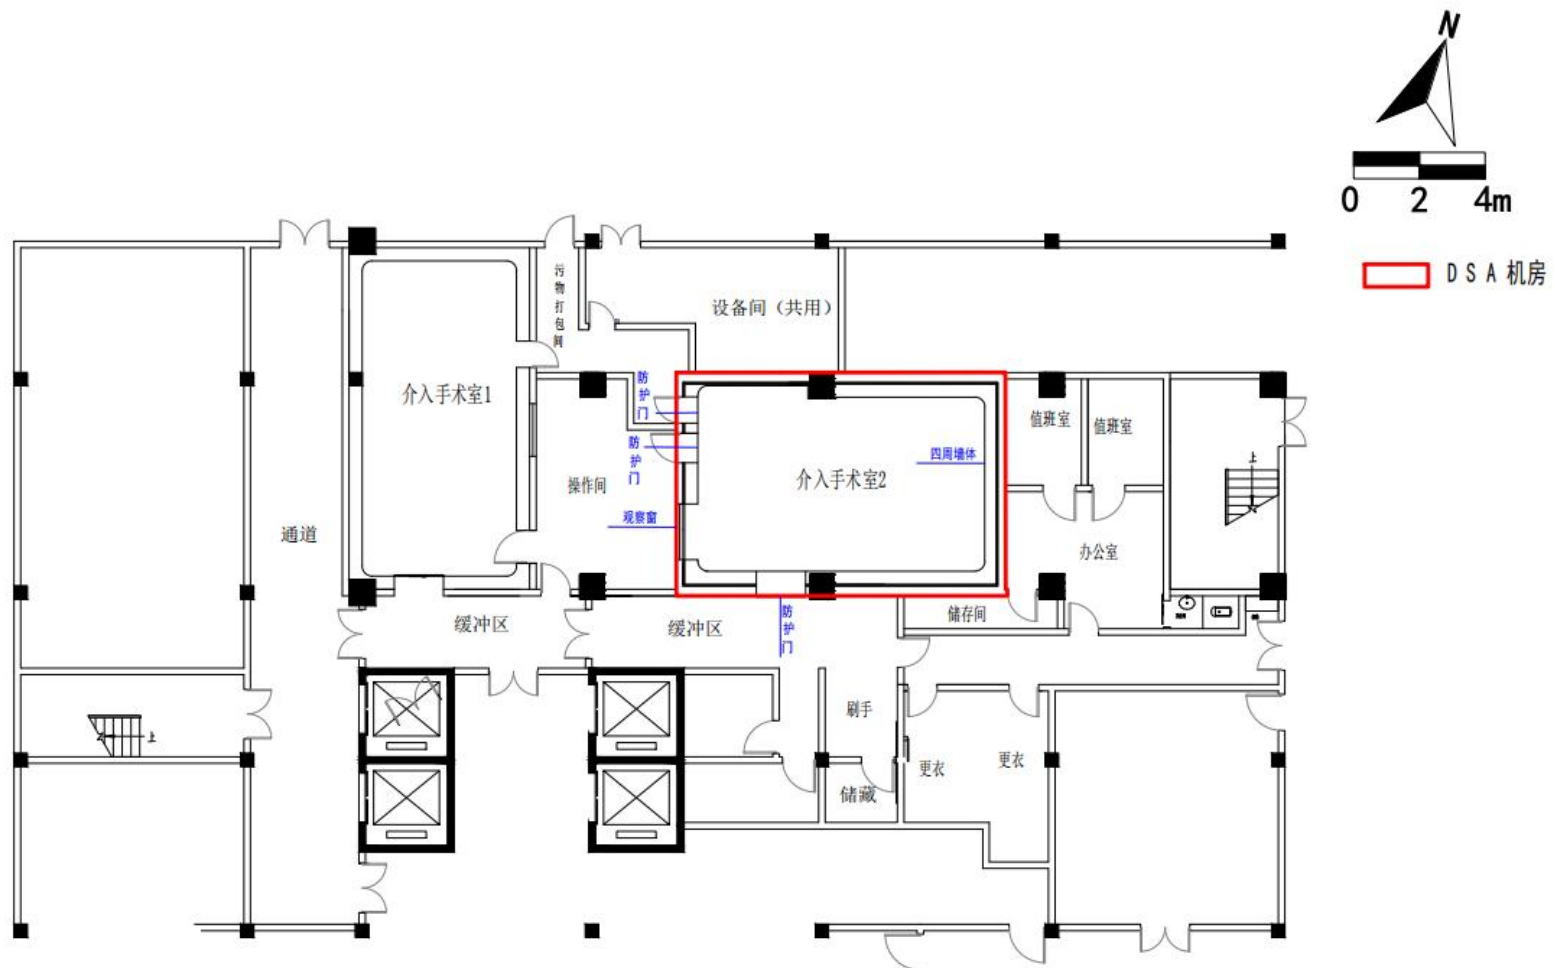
现介入手术室 2 平面布置图 (3 号楼一层)
